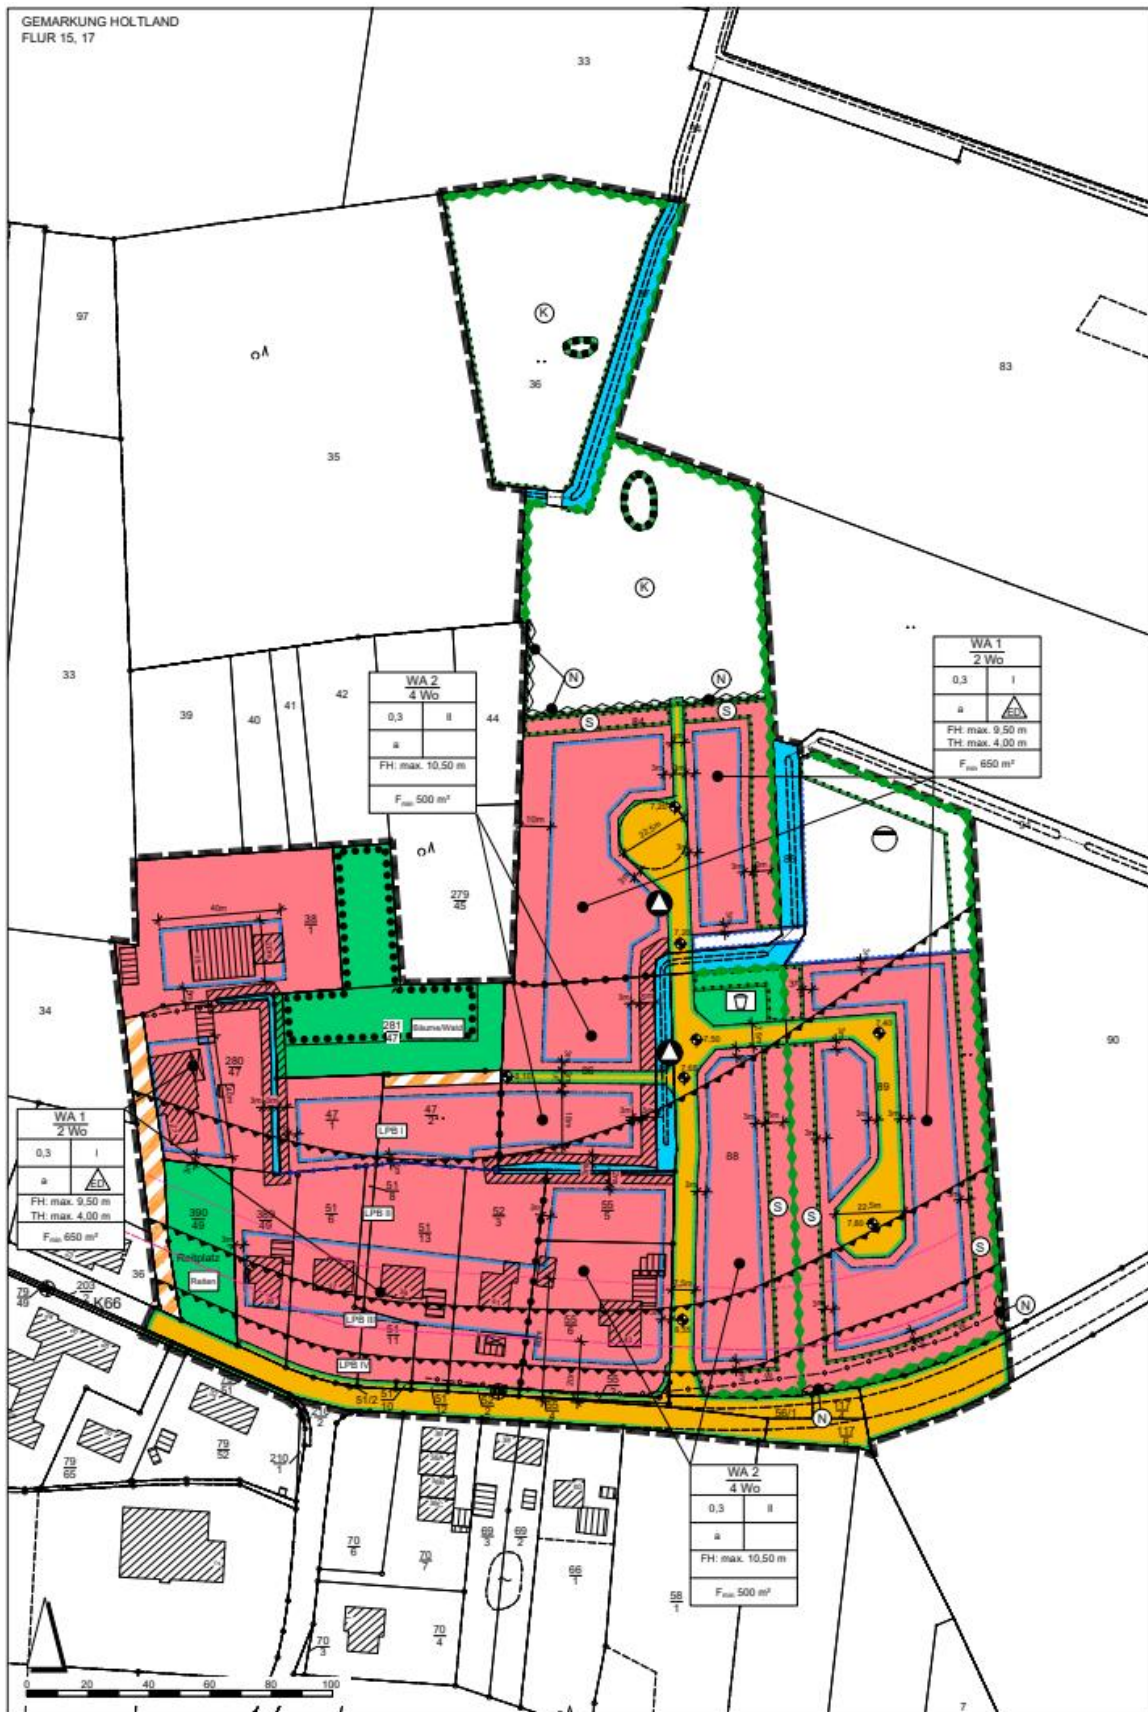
Planzeichnung HO 06 – Entwurf 15.01.2025
